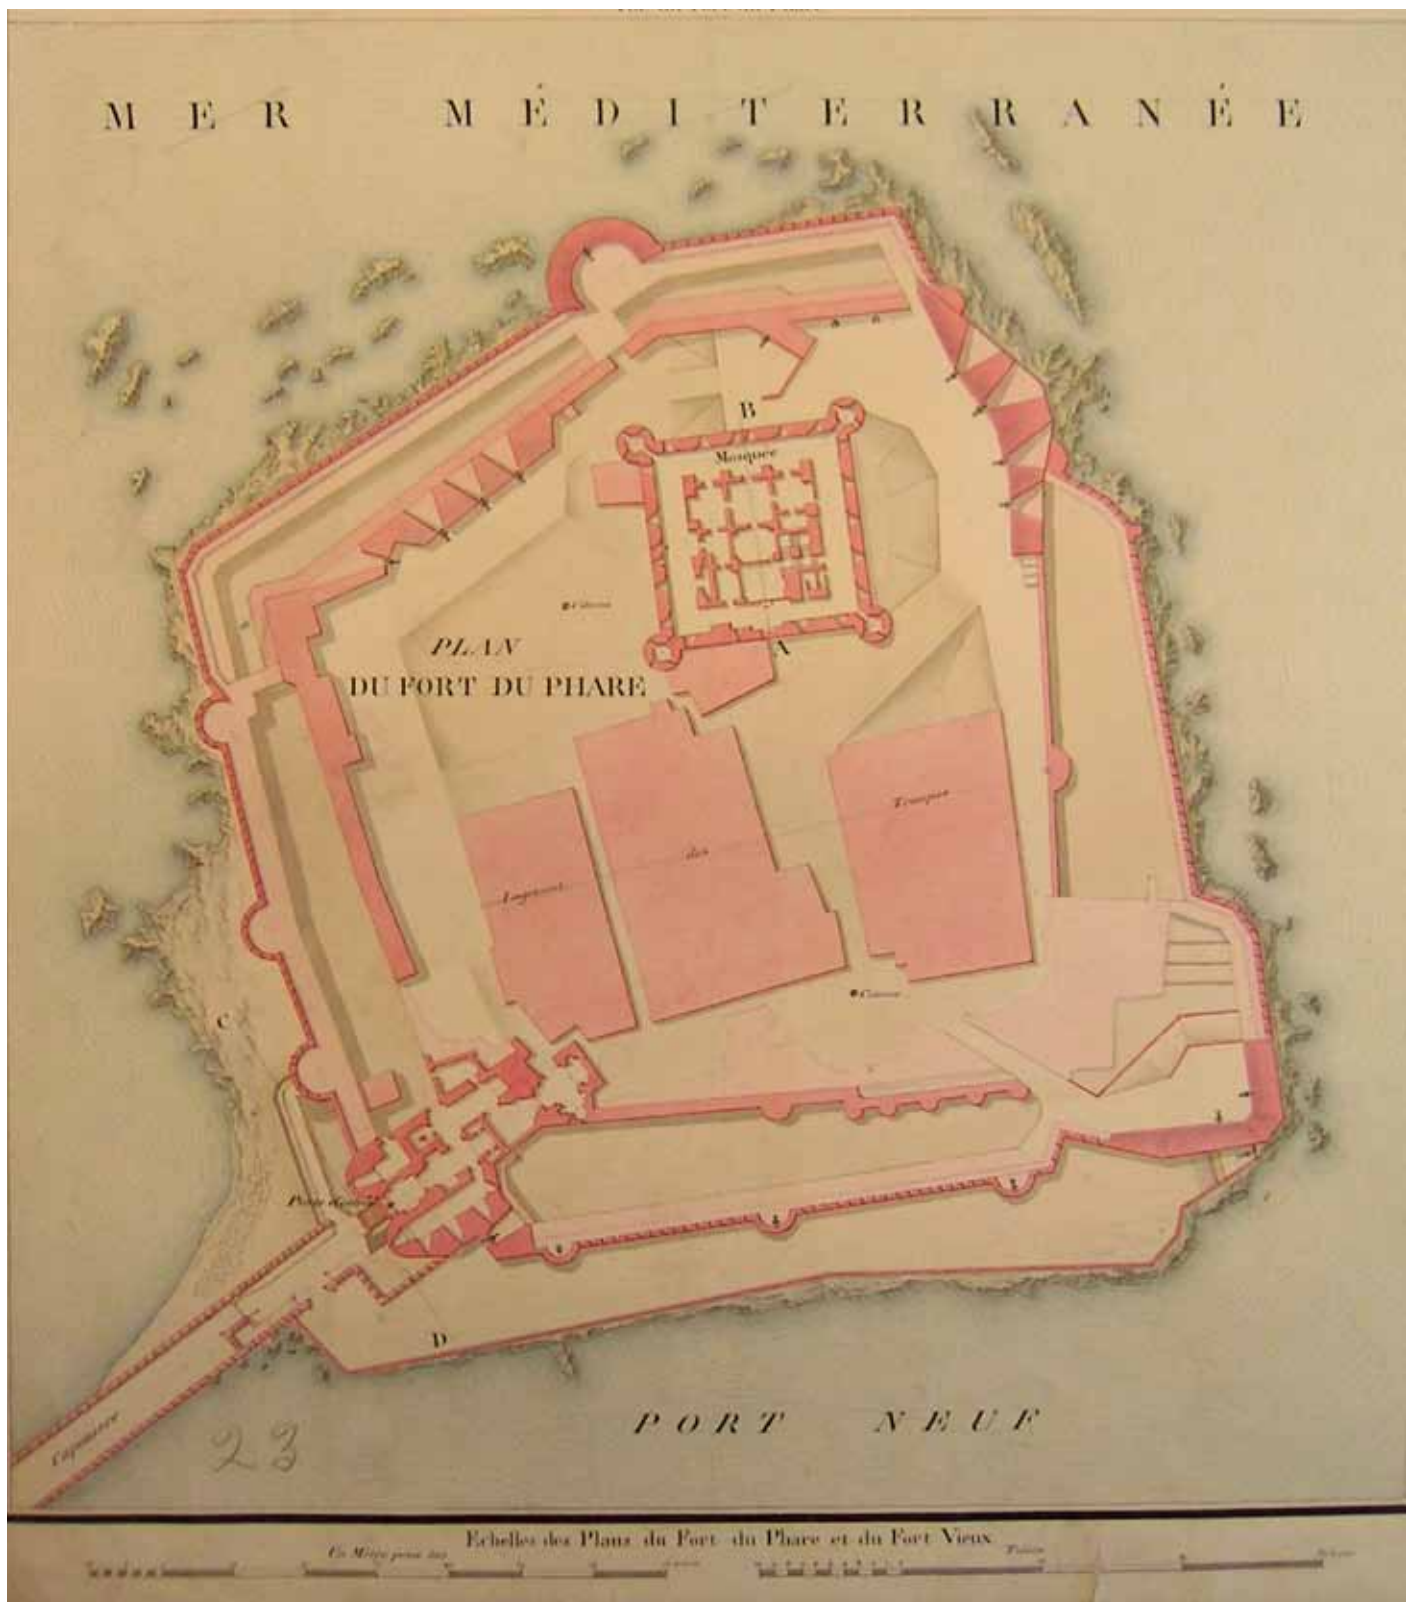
Lageplan: Armée d'Orient, 1798 (SHAT - L II 23, Nr. 63).
